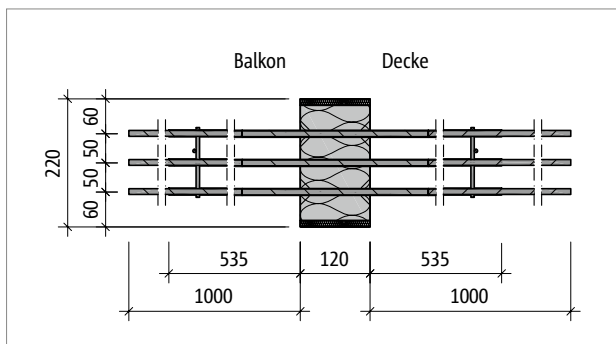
Schöck Isokorb® XT Typ BP: Produktgrundriss
